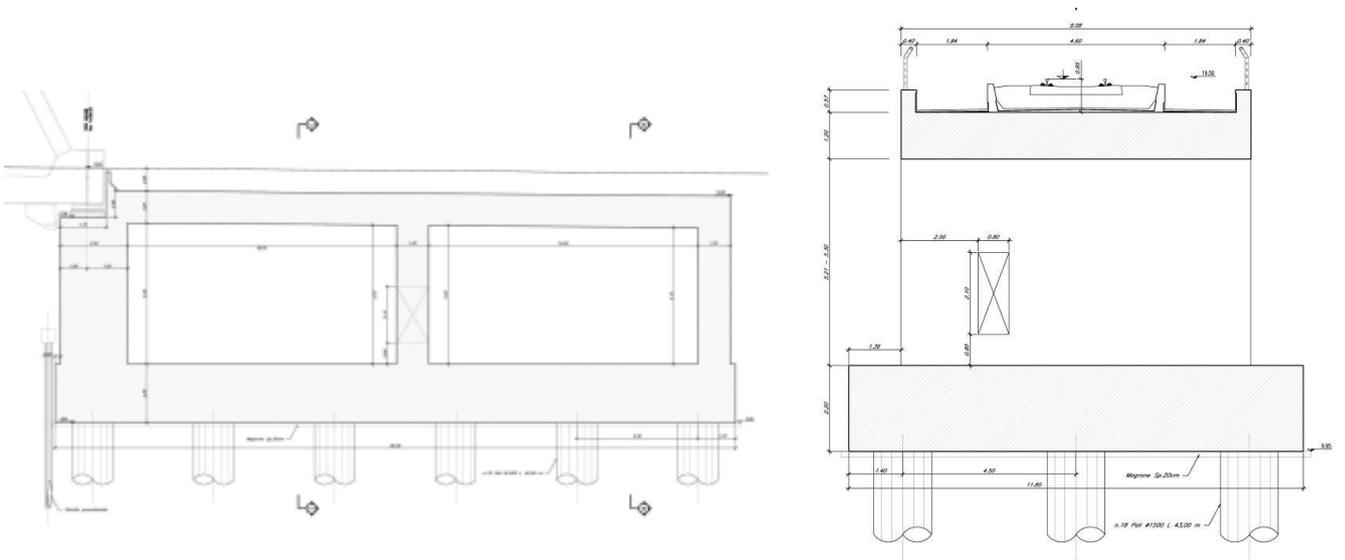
Sezione longitudinale spalla (sinistra) e Sezione trasversale della spalla (destra)
